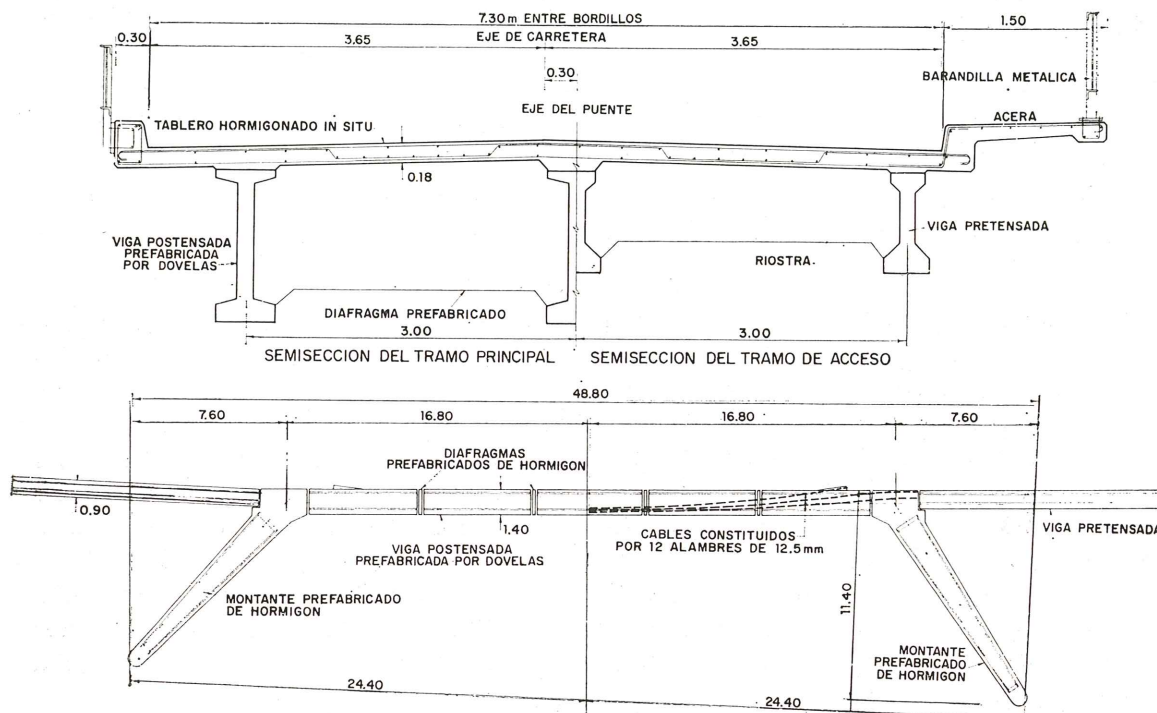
Secciones transversales tipo del tramo principal y de los tramos de acceso.
